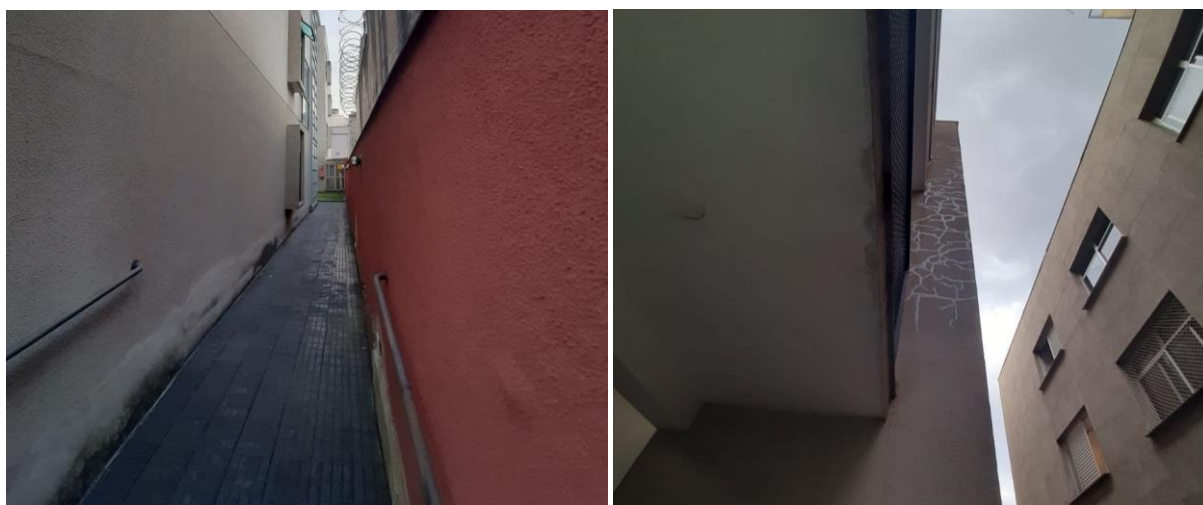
Infiltrações nas fachadas norte e sul dos Estúdios Capelinha
